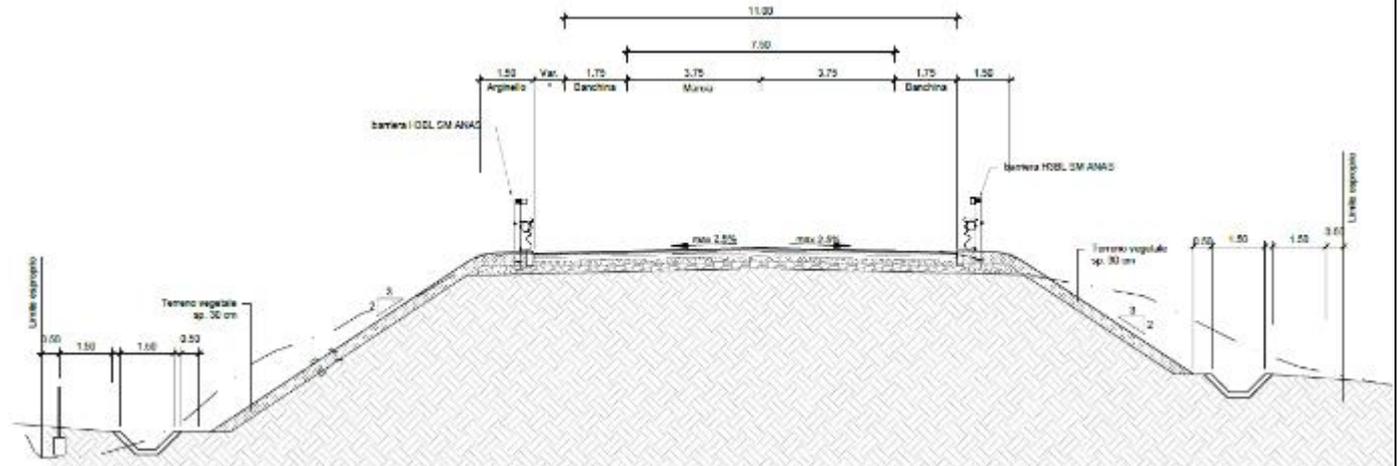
Sezione tipo in rilevato a singola carreggiata su sedime esistente
